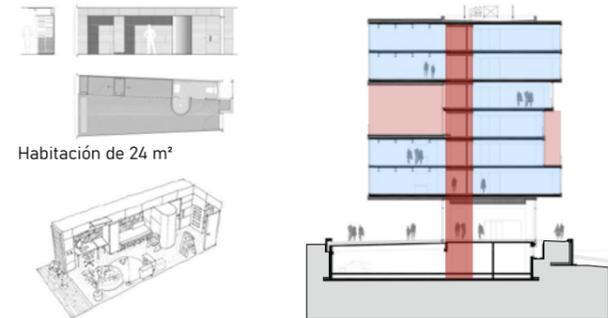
Sección esquemática edificio Tietgen Dormitory Fuente. Autoría Propia
